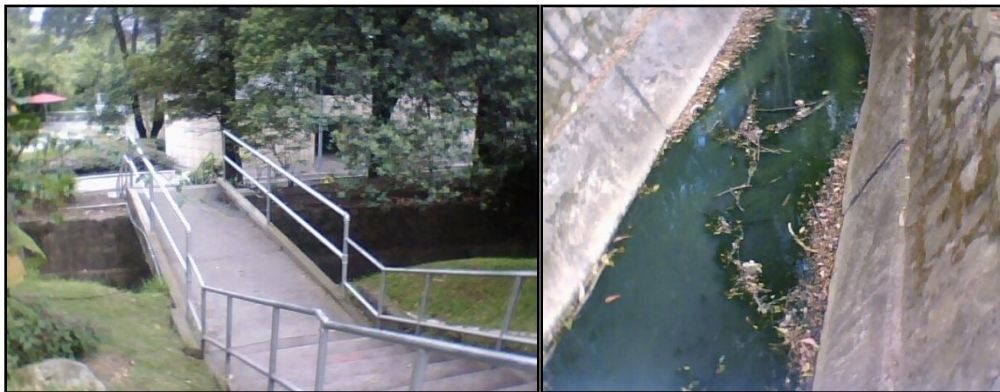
Canal PUJ – Acceso a las canchas múltiples (Autor, 2011).
